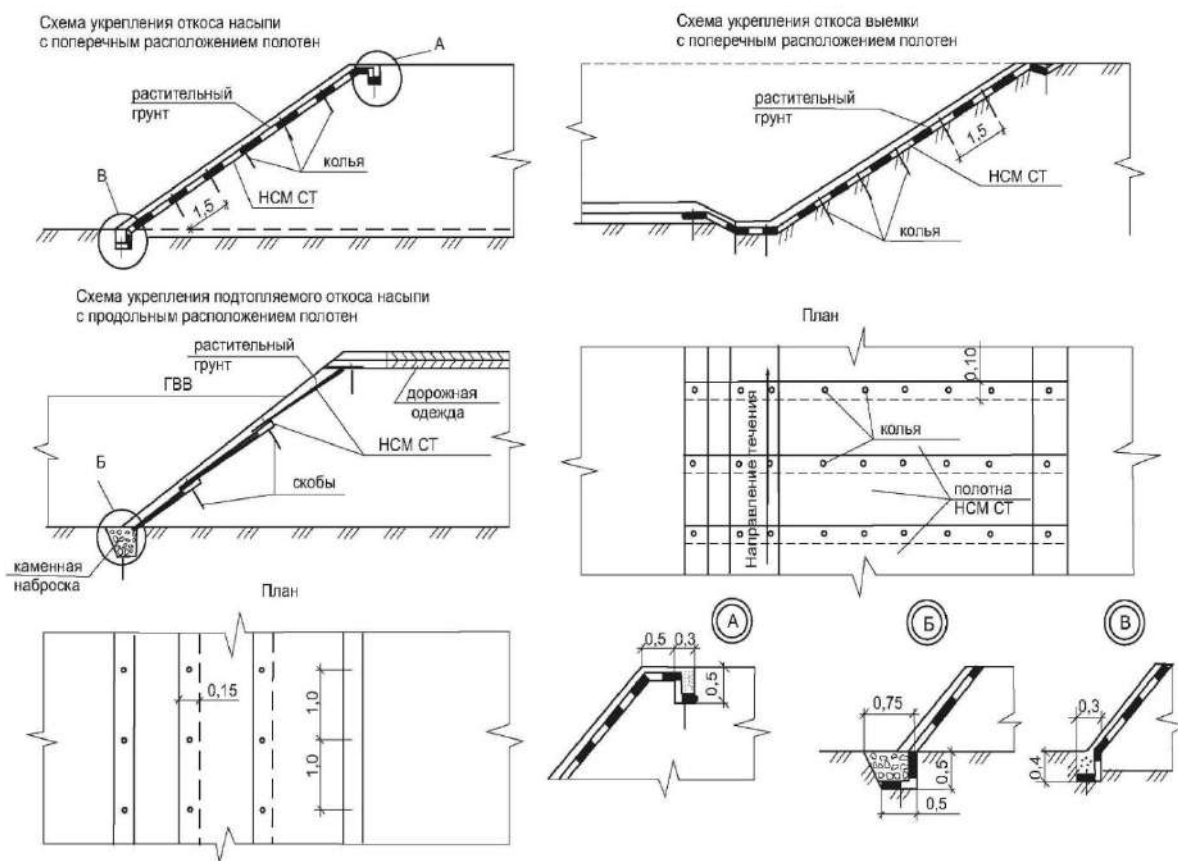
Схема монтажа геосеток (геотекстиля) на откосах
